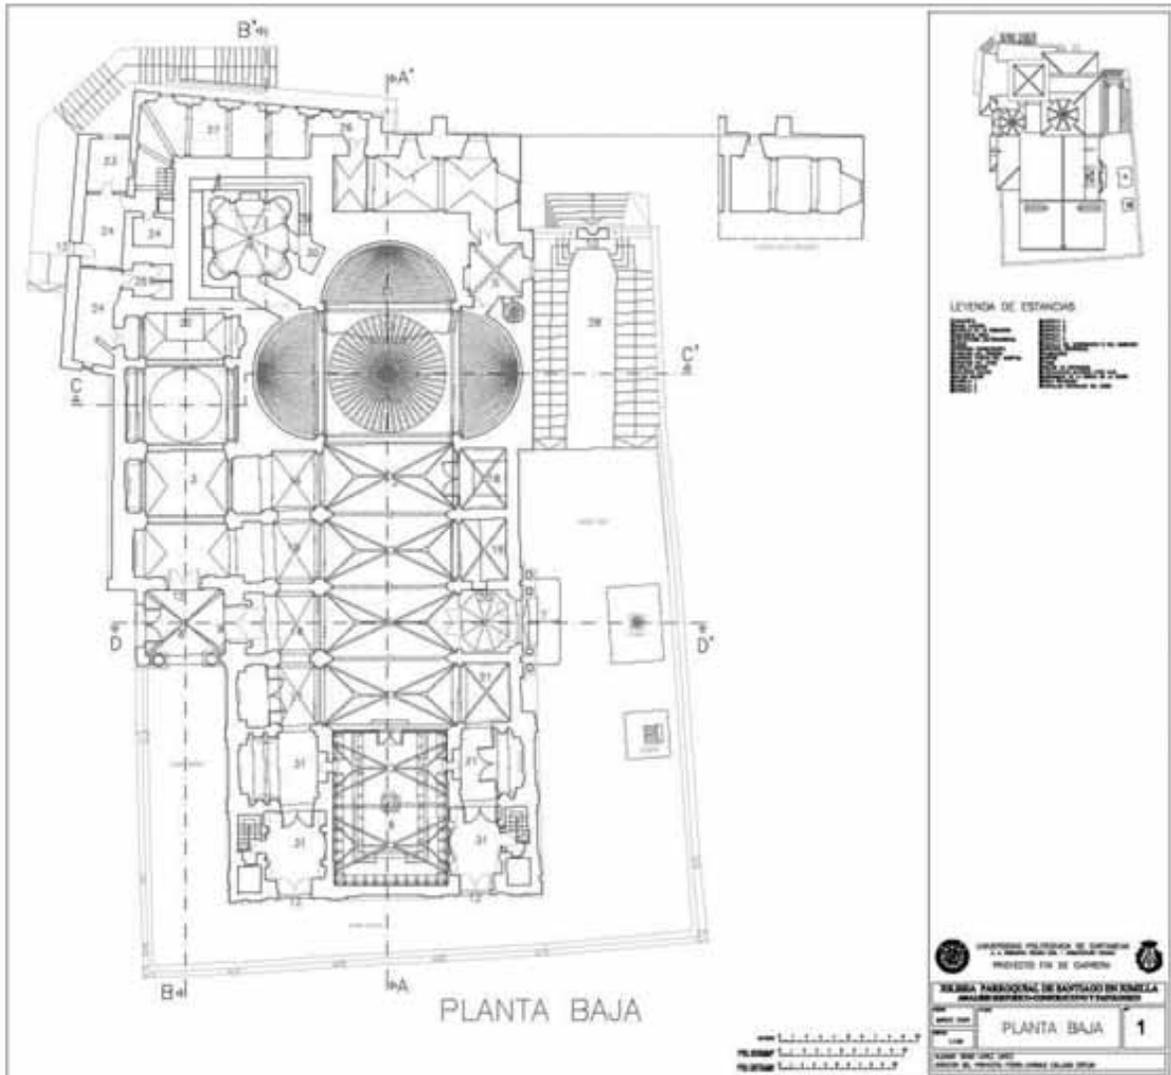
Plano de planta de la iglesia parroquial de Jumilla levantado por el equipo de trabajo de la UPCT.
